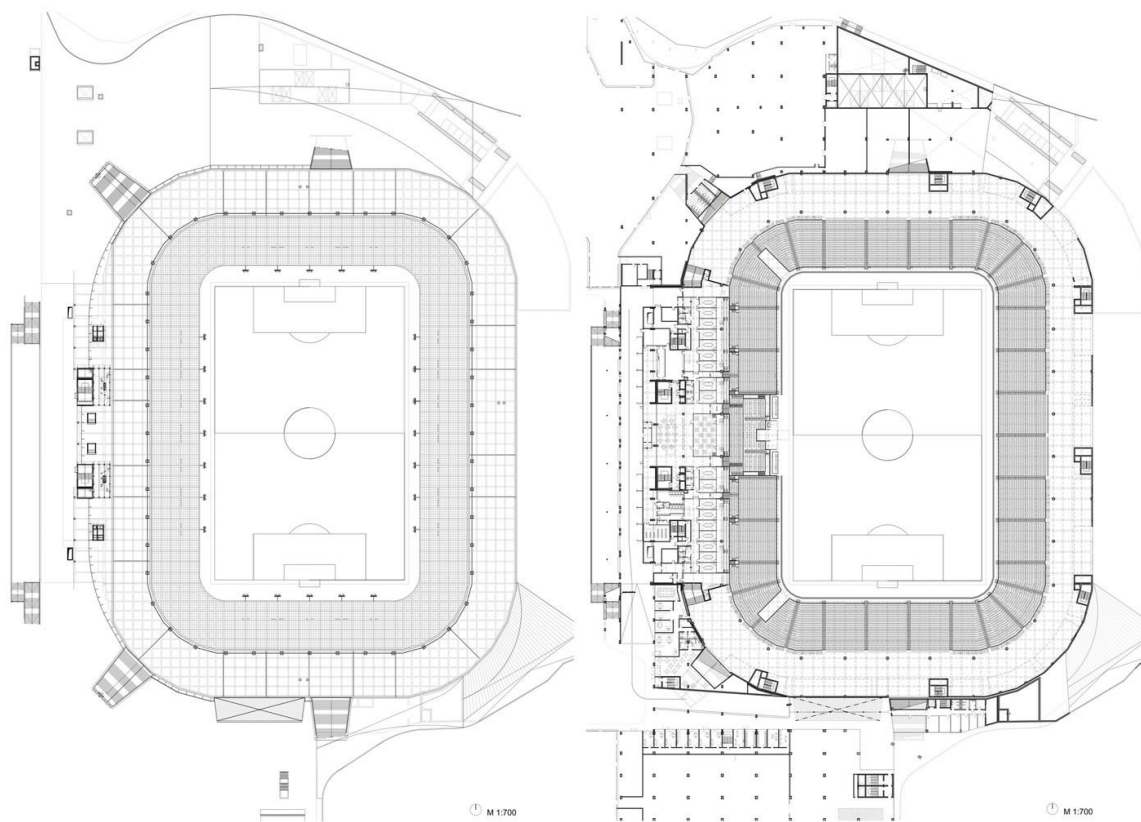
Plantas arquitectónicas del Parque deportivo Stozice.
